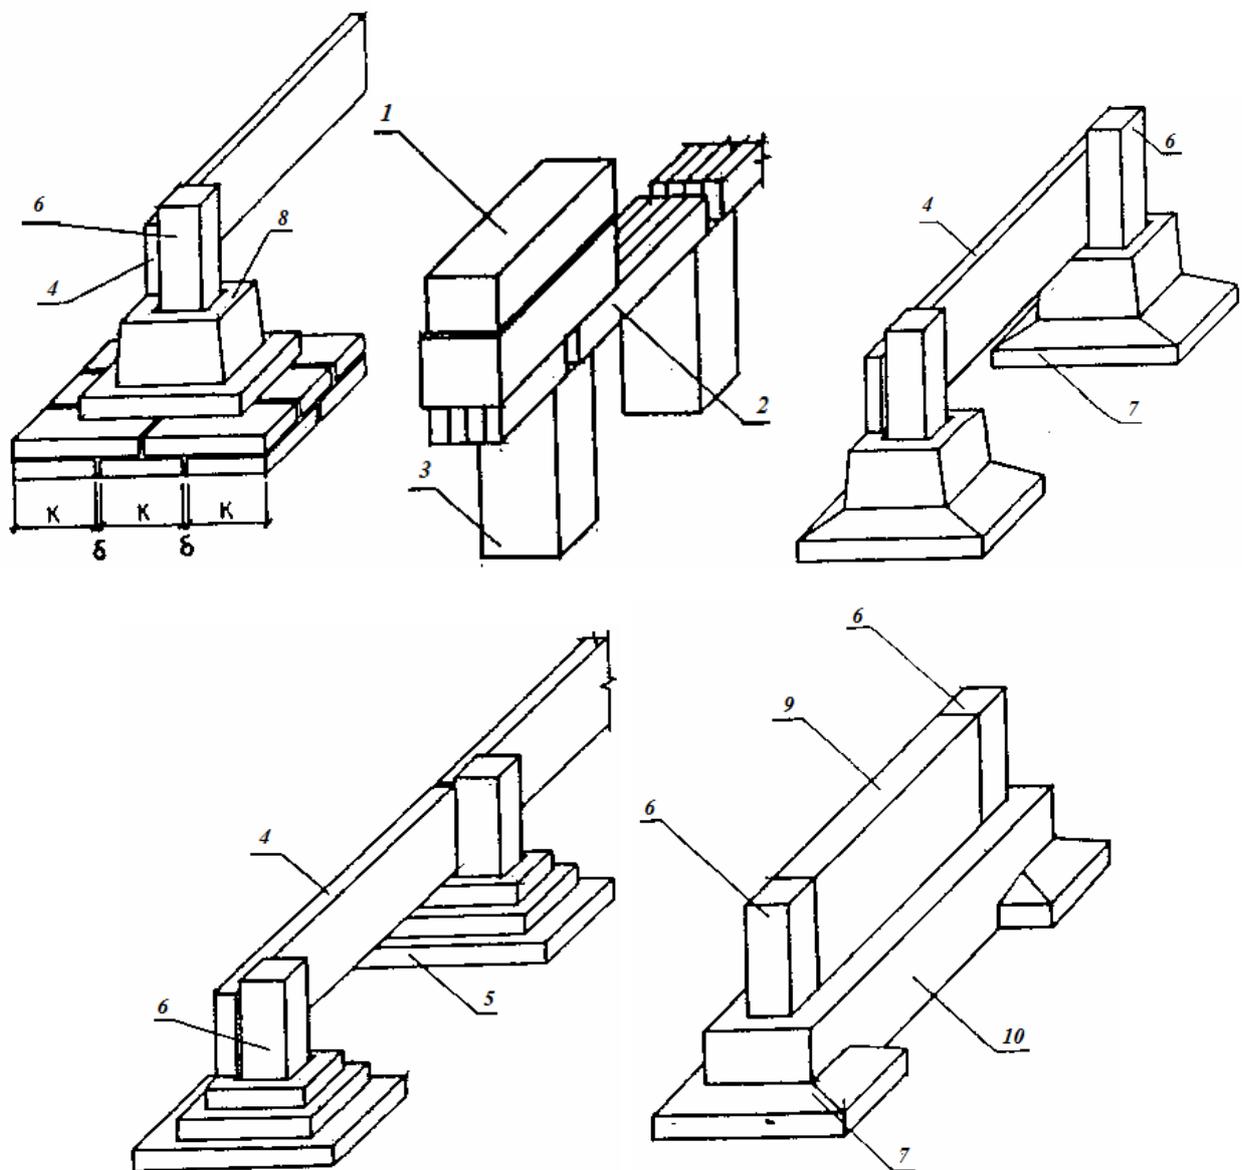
Фундаменты каркасных зданий и отдельно стоящие фундаменты: 1 — наружная стена; 2 — сборная перемычка; 3 — столбчатый фундамент; 4 — цокольная панель; 5 — монолитный фундамент; 6 — колонна; 7 — фундамент; 8 — сборный фундамент; 9 — самонесущая стена; 10 — заполнение пространства бетоном
